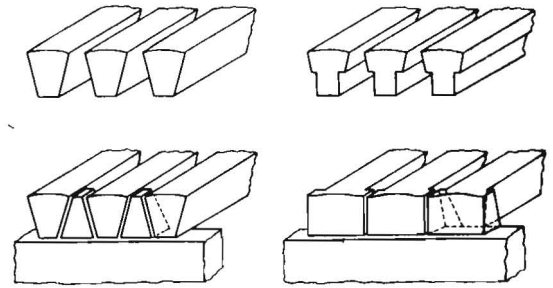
Profilformen der Betonbalken und Möglichkeiten zur Schaffung des gewünschten Spaltenabstandes
